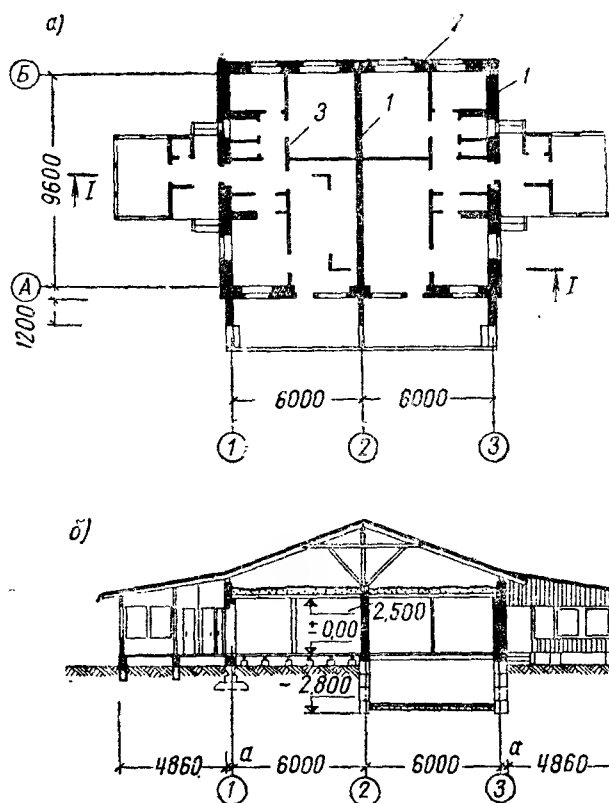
Малоэтажное каменное здание с продольными несущими стенами
